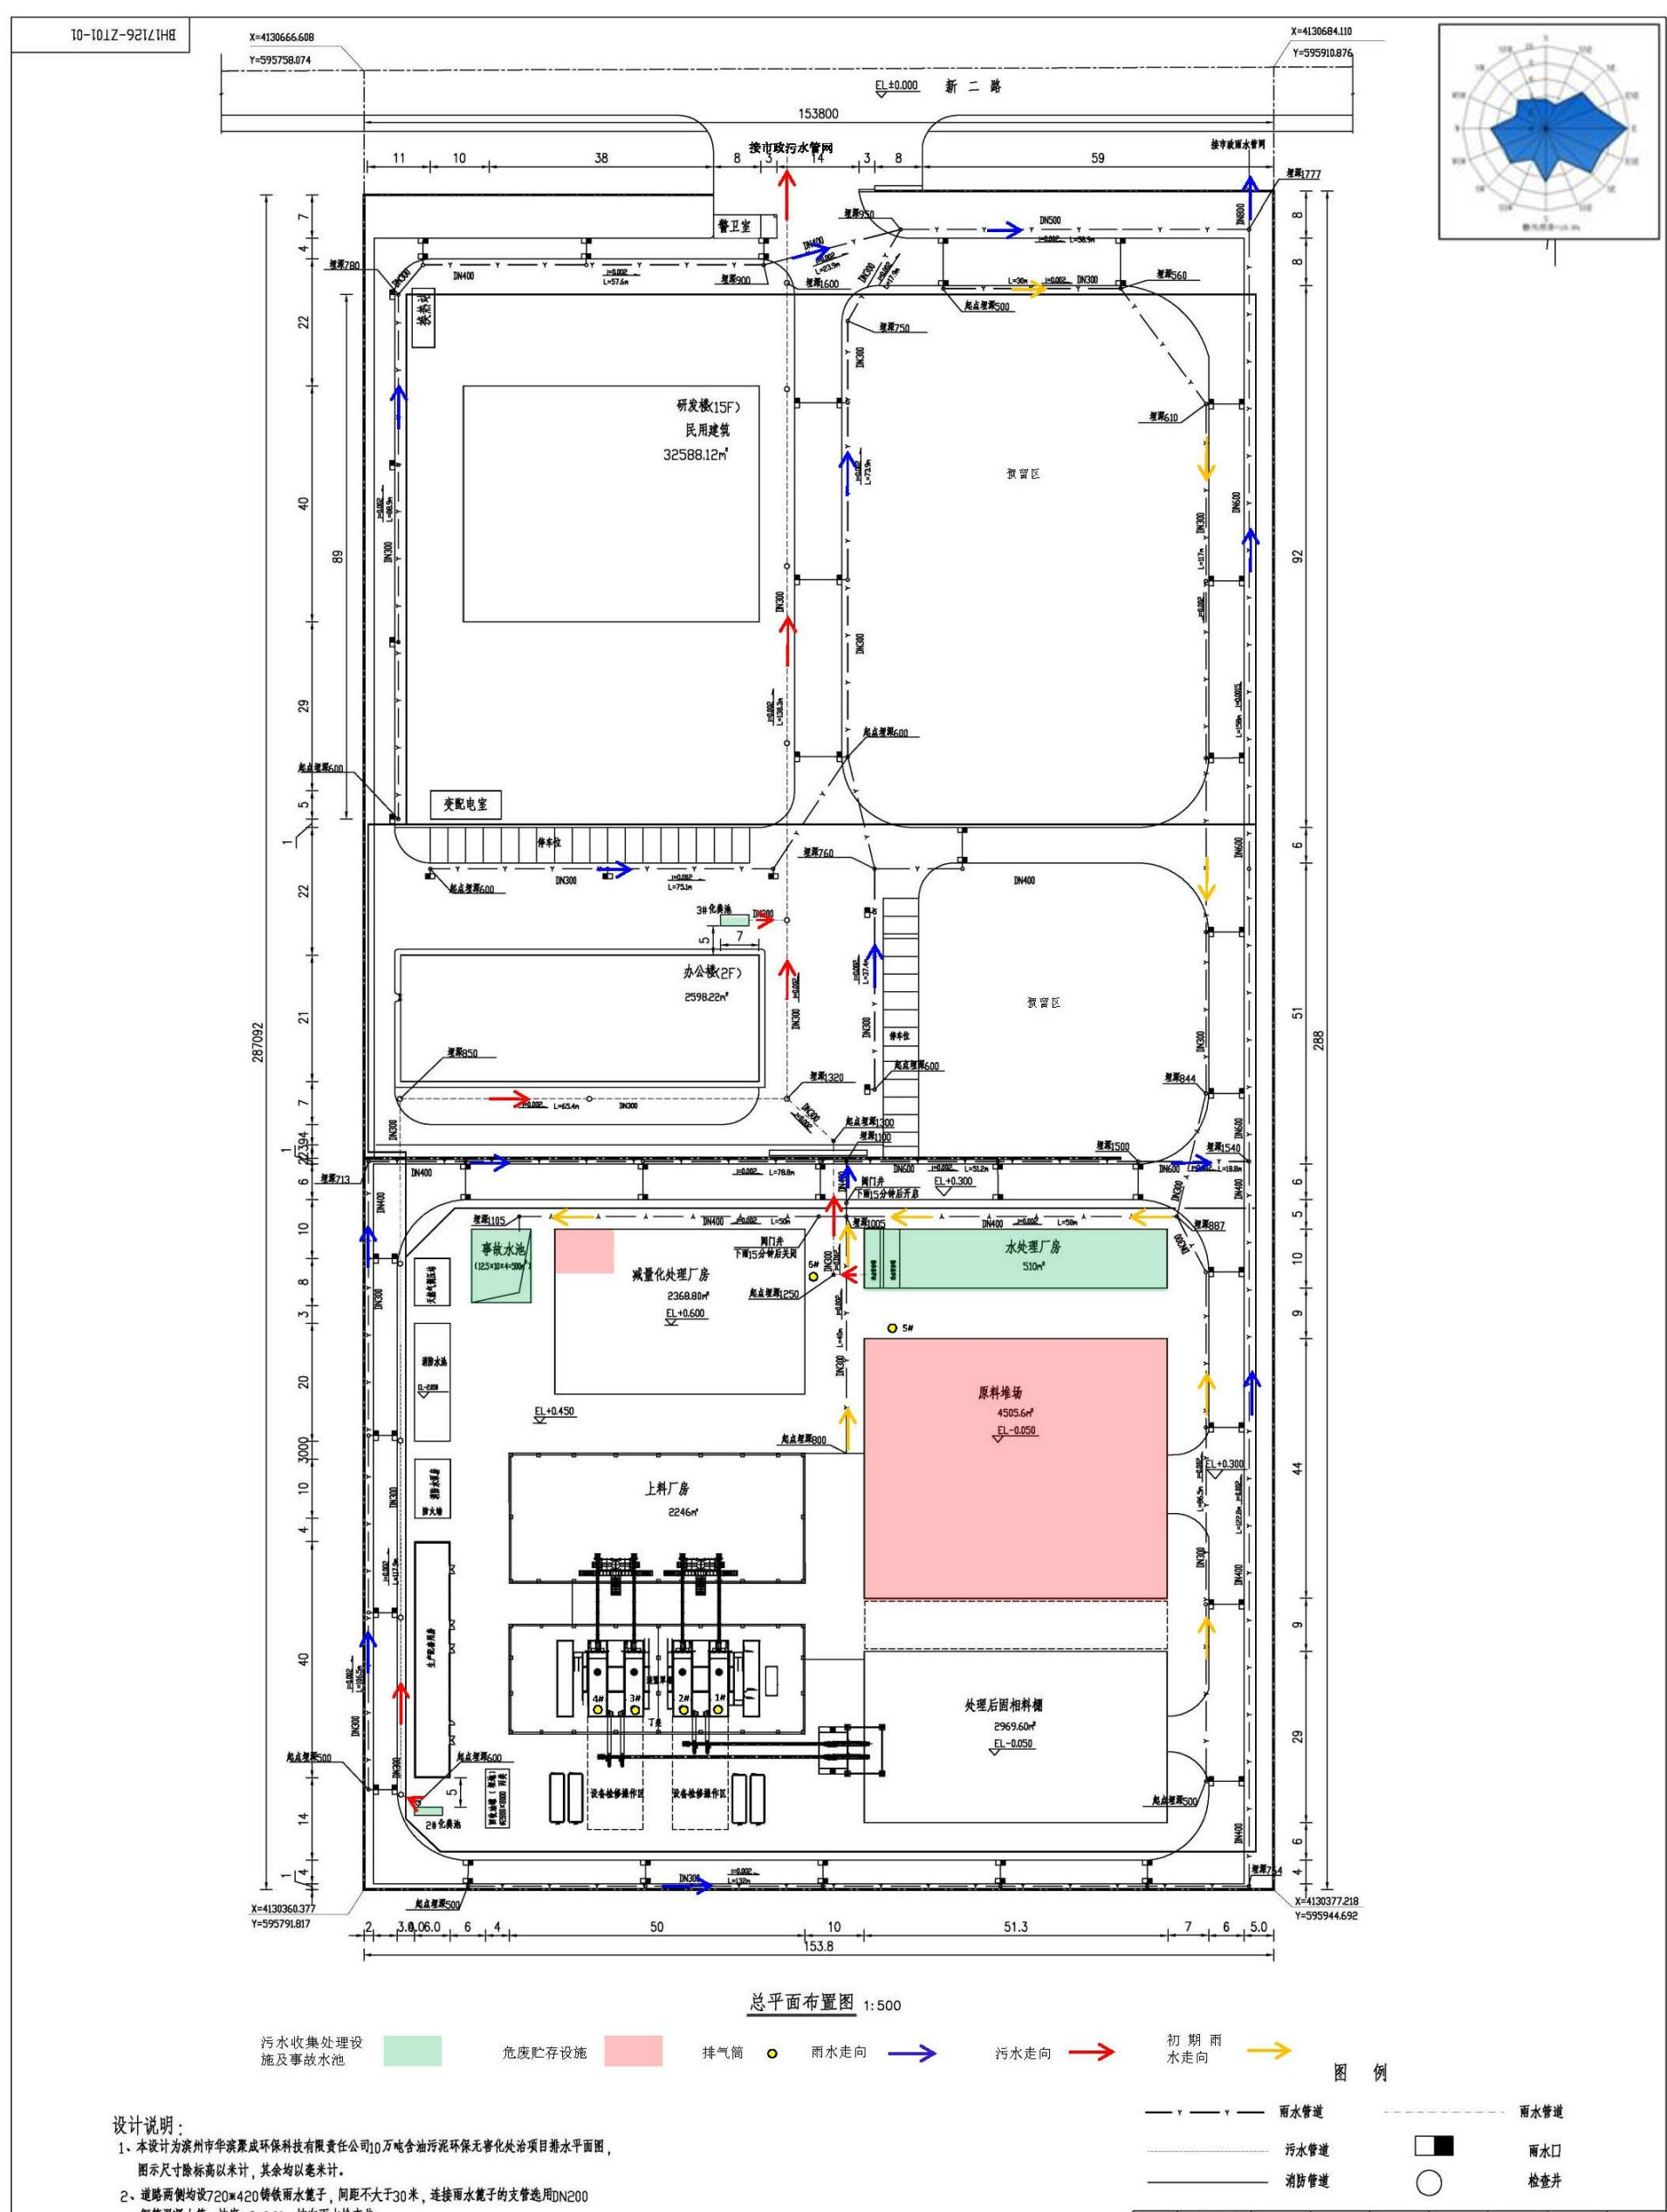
项目环评阶段平面布置图 (比例尺 1:500)
